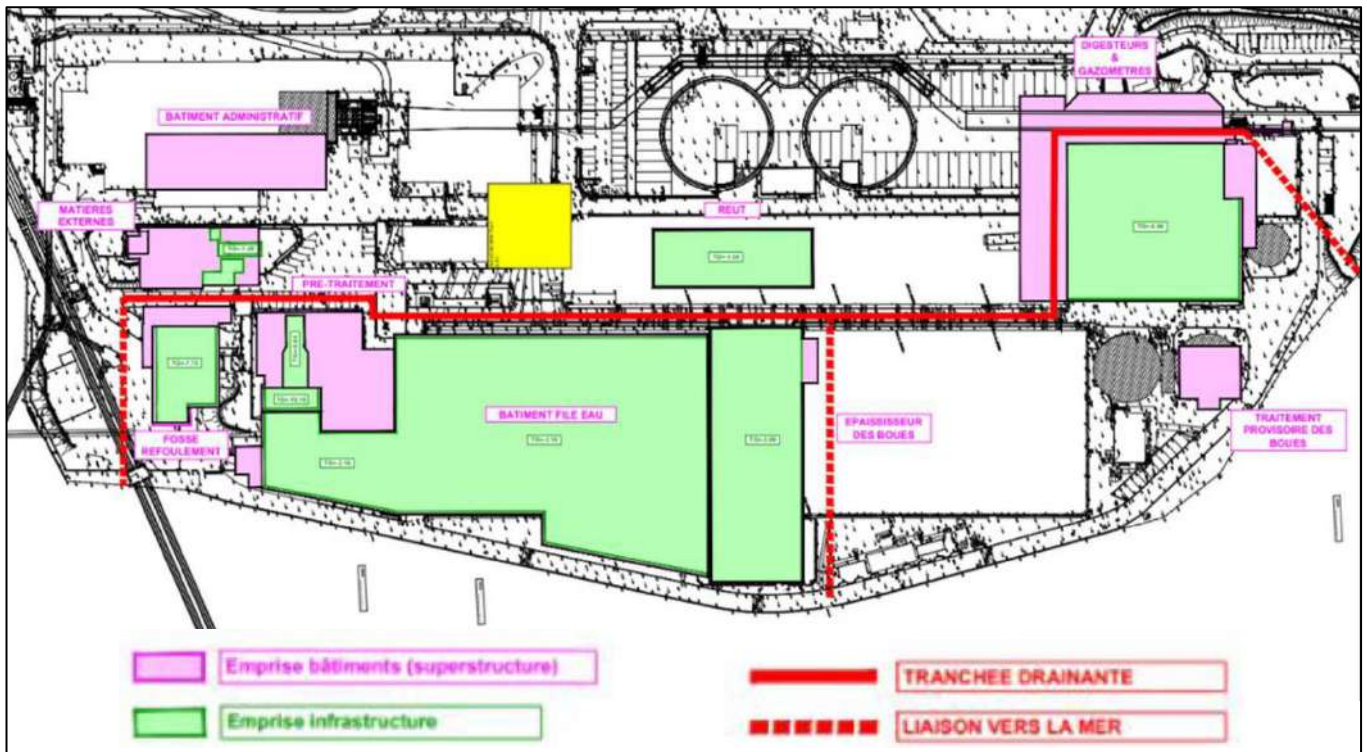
Implantation du dispositif d'écêtement de la nappe pour garantir la continuité hydraulique
